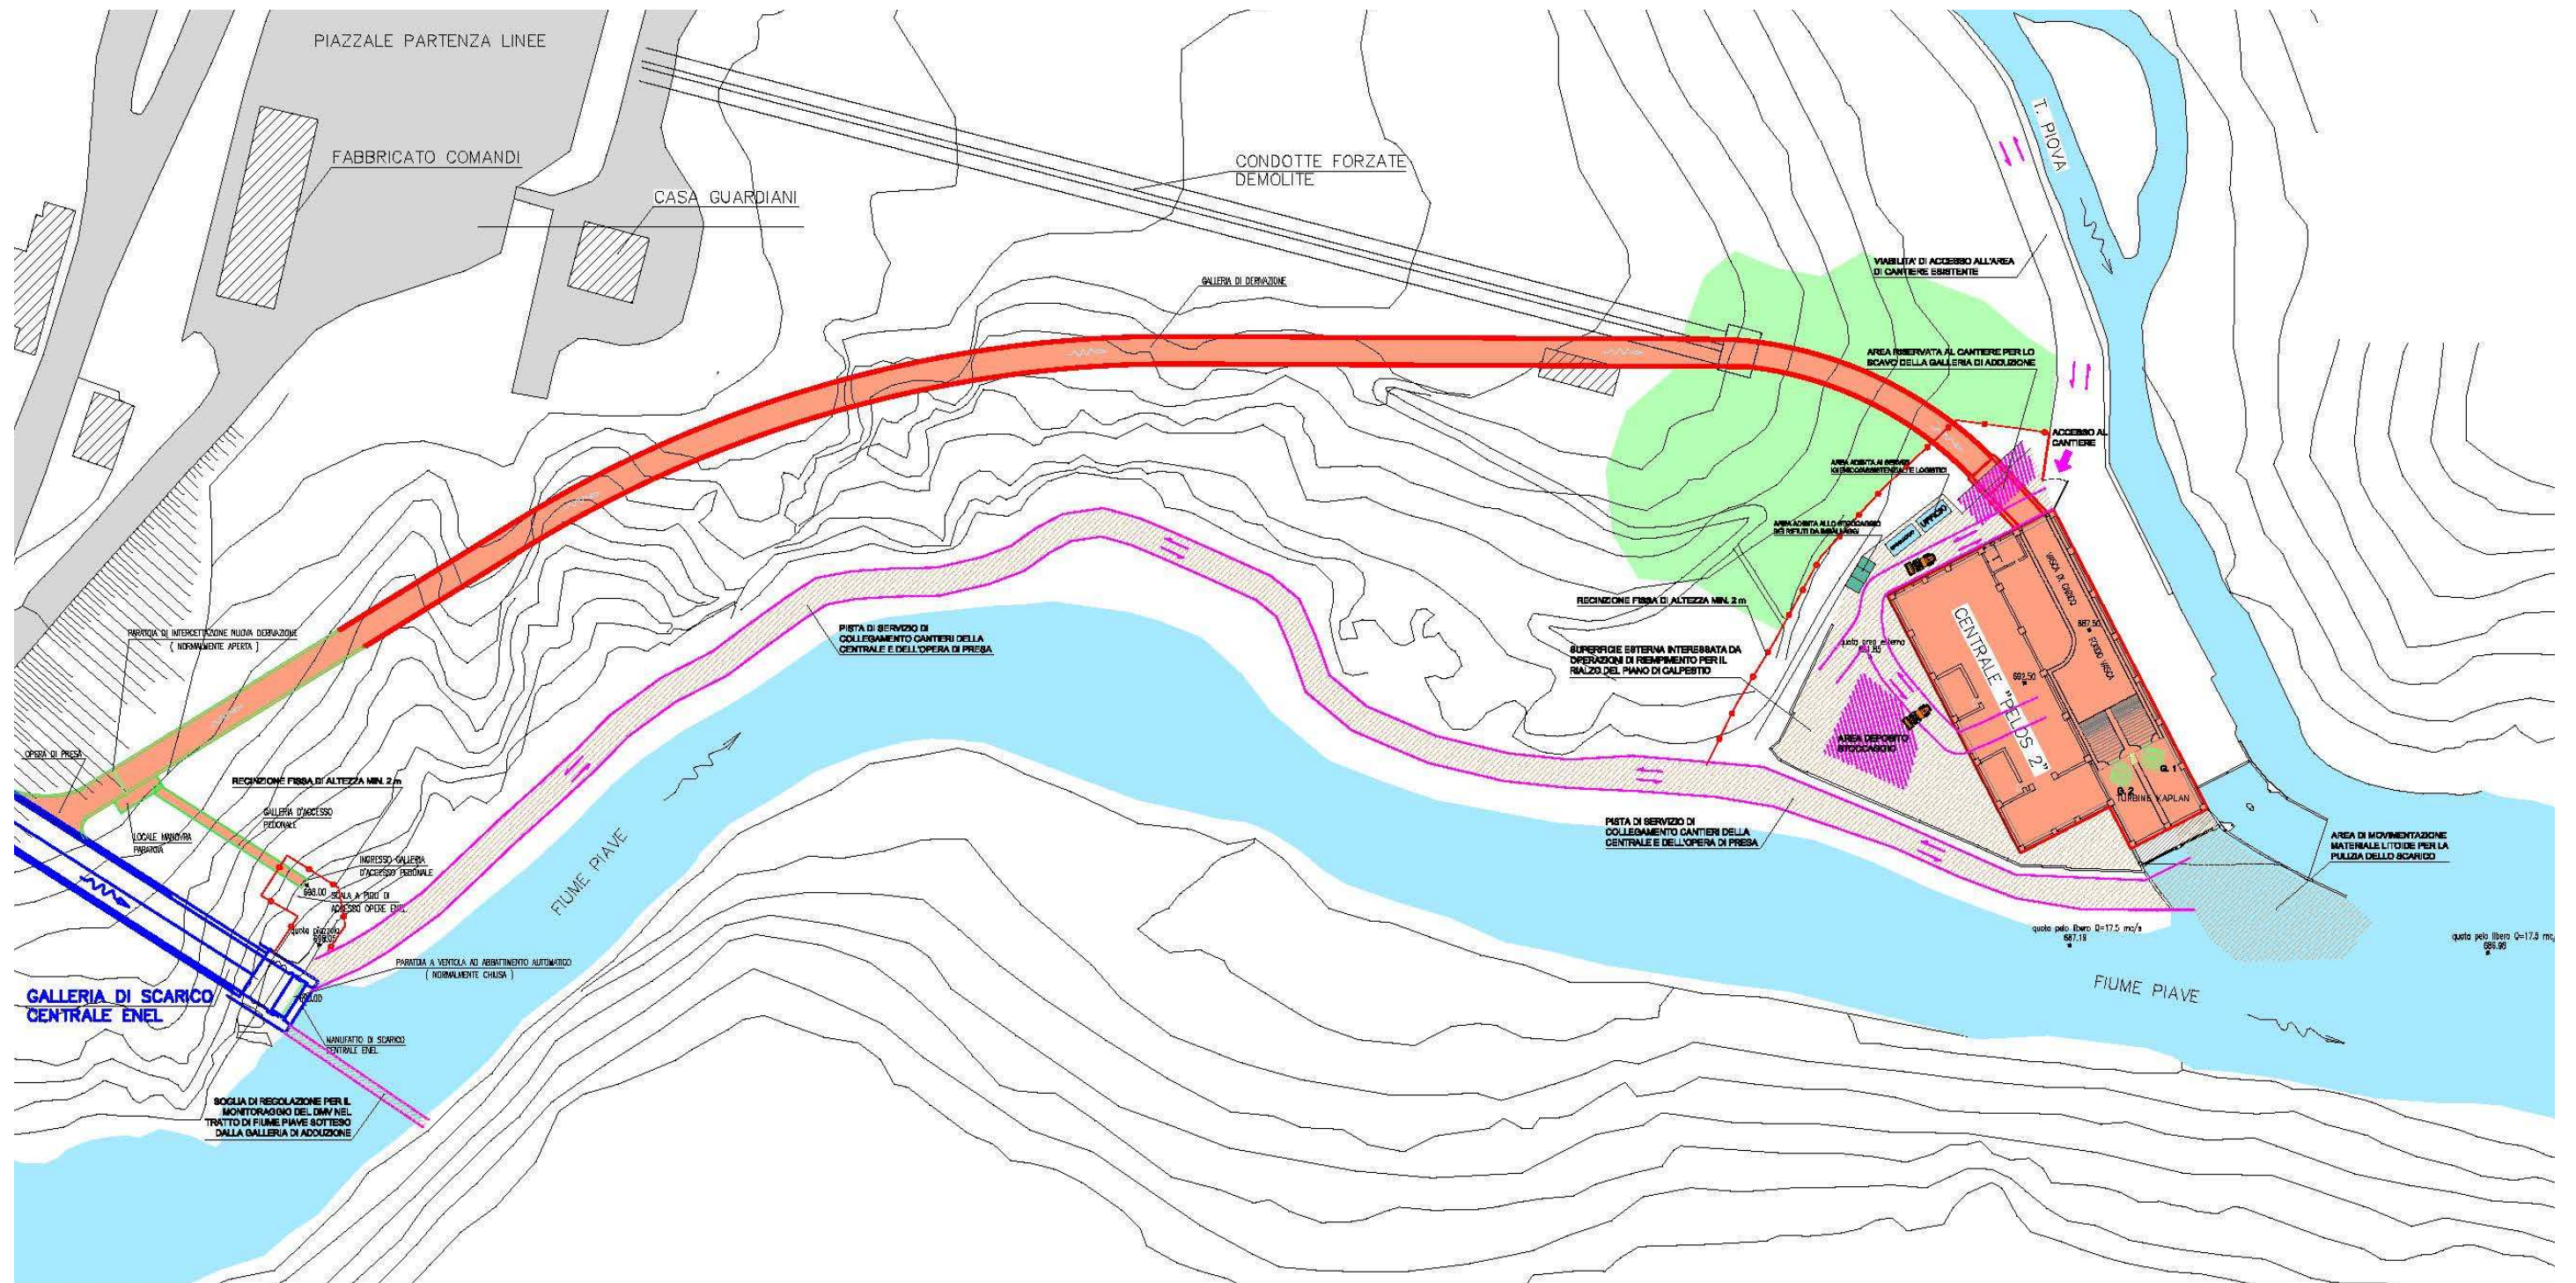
Planimetria di cantiere con evidenziate, in particolare, le aree di occupazione delle opere civili previste dal progetto.
